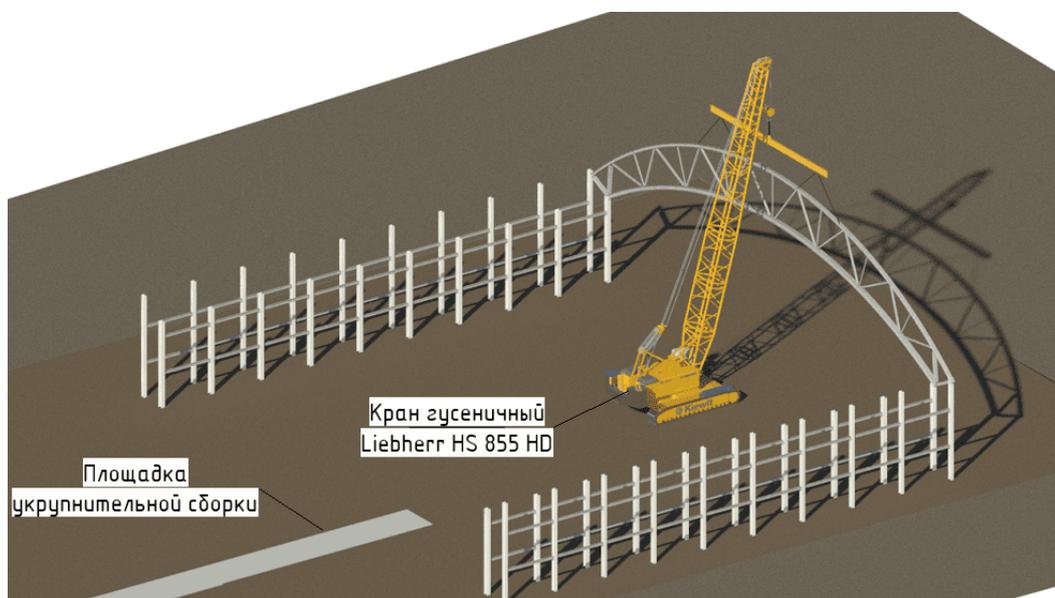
Общий вид монтажа фермы одним гусеничным краном
